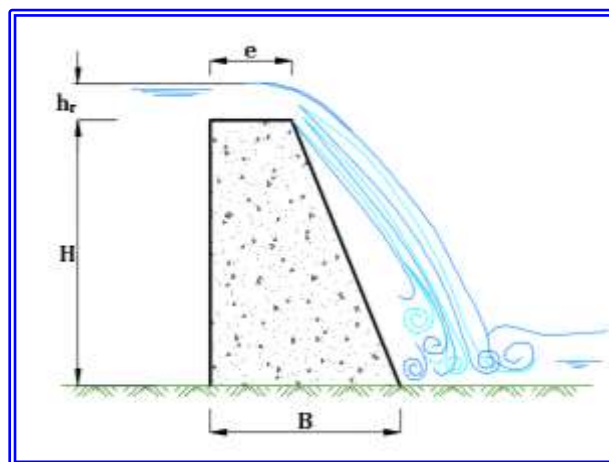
Sección típica con procedimiento utilizado en Austria.- (Imagen tomada de López Cadenas De Llano, Filiberto, 1965 y redibujada para este libro).
